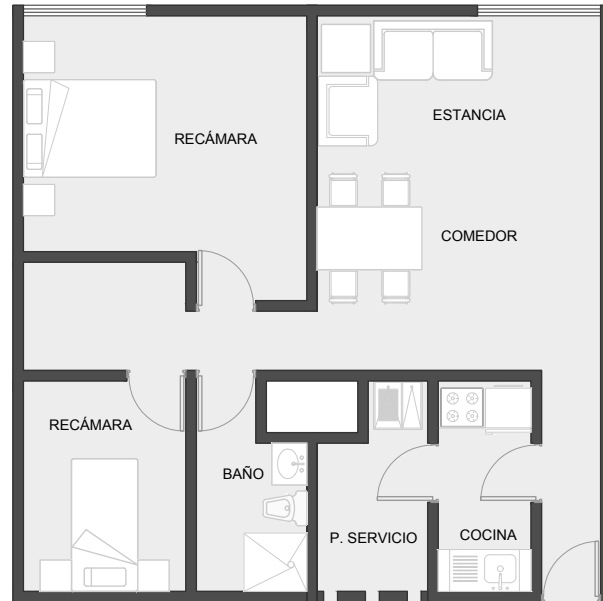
Planta arquitectónica original departamento tipo A-01 Fuente: Elaboración propia
